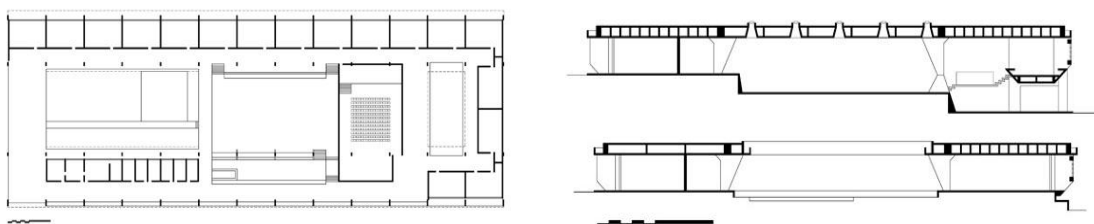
Escola de Guarulhos, Planta e cortes. Disponível em <<http://goo.gl/CL0gyt>> acesso em abril de 2014
